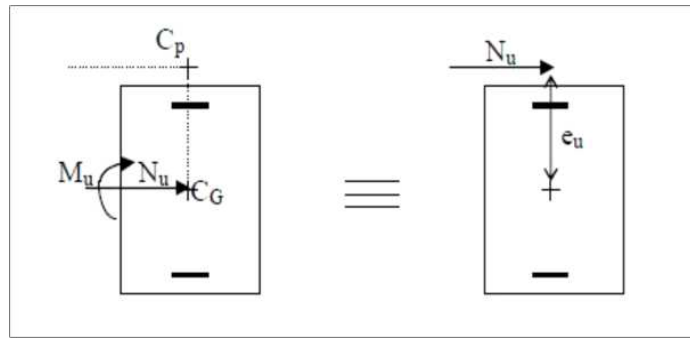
section rectangulaire soumise à la flexion composée.
